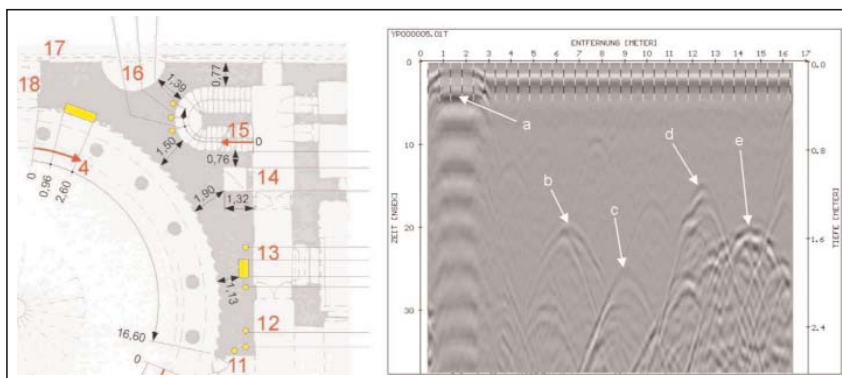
Radarmessungen an der Innenseite des Mauerwerks der Rotunde. Links: Ausschnitt aus dem Grundriss. Die mit Radar georteten Hohlstellen sind gelb markiert, rechts: Radargramm mit Reflexionen an den Hohlstellen (a: Raumheizung, b: Treppenhaus, c: kleine Kammer, d: kleine Kammer, e: Wandrückseite)
